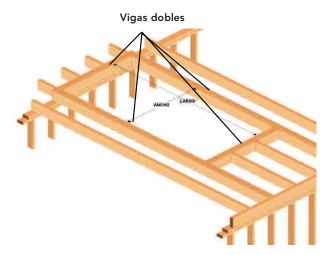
52: Escotilla necesaria para pasada de escalera, se coloca doble viga como cabezal y refuerzos donde se apoyarán las otras vigas.
